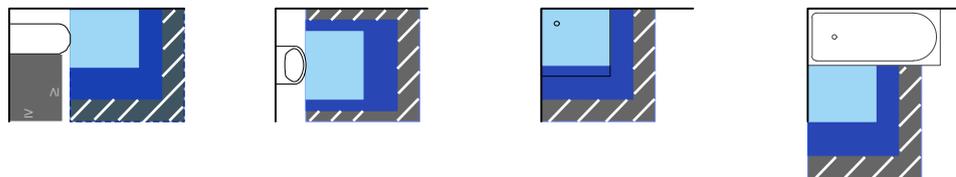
Bewegungsflächen vor Sanitärobjekten nach DIN 18022:1989-11, DIN 18025:1992-12, bzw. DIN 18040:2011-09 Deutsche Planungsgrundlagen nach DIN 18022 (hellblau) und Anforderungen an Einrichtungen und Bewegungsflächen nach DIN 18025-2, bzw. 18040-2 barrierefrei (dunkelblau) und rollstuhlgerecht (schwarz)
